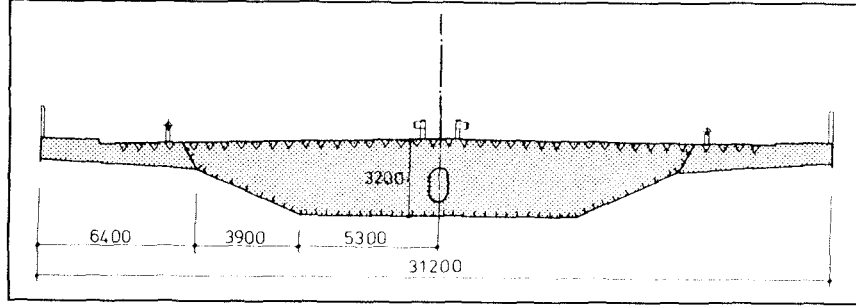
Tüm döşeme kirişleri eğik elemanlarla tutulu olan rijitlik kirişine sahip Friedrich Ebert Köprüsü.
